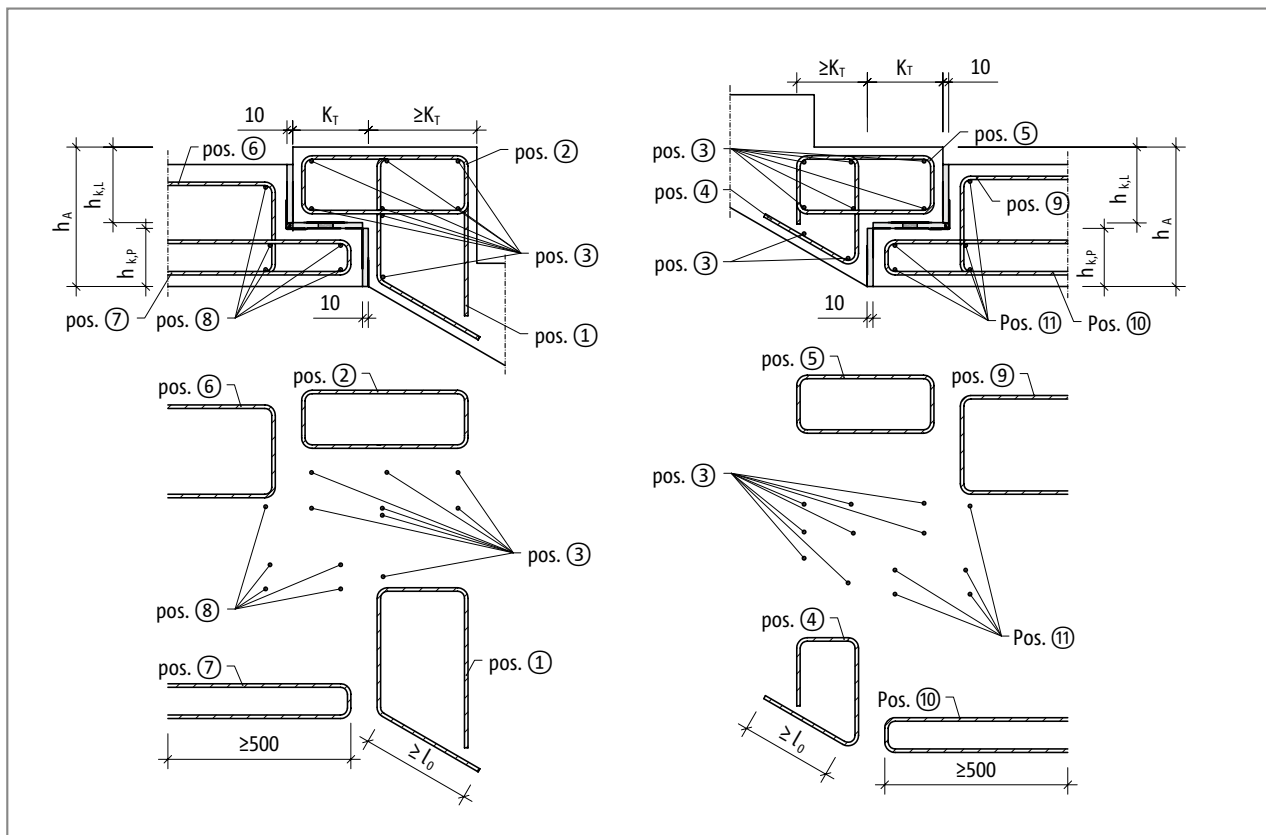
Schöck Tronsole® typ F: Dimenzování
